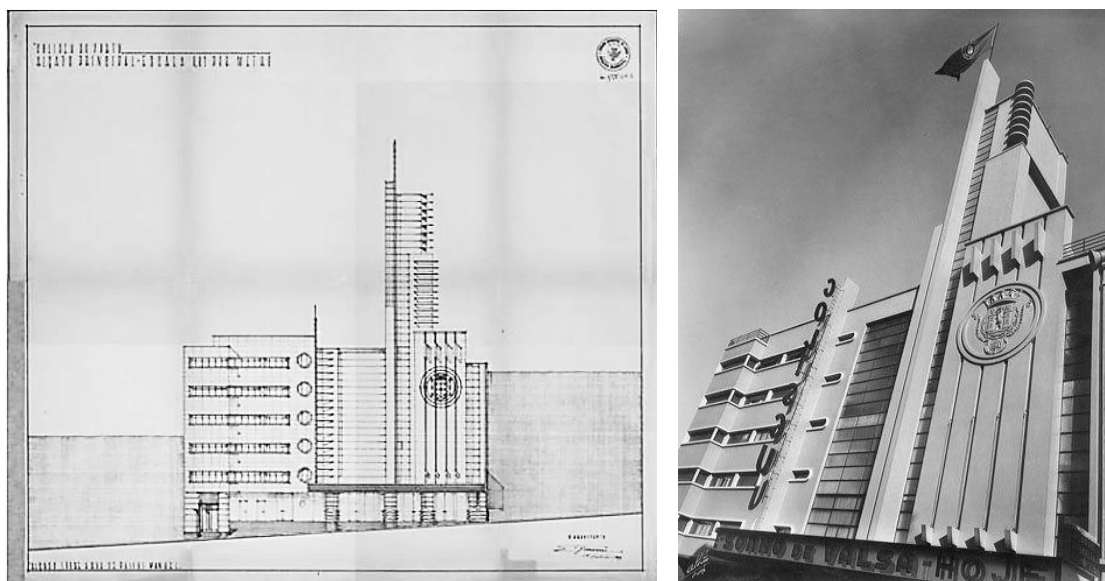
e 4.9 - Alçado Principal: Coliseu do Porto, por Cassiano Branco, e Vista de Fachada de autor não identificado, adaptado de [57][49].
